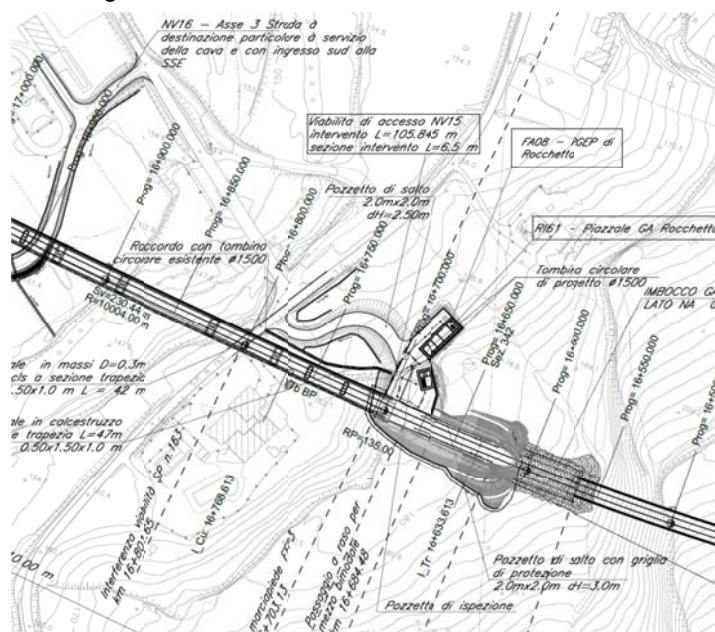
Galleria Rocchetta imbocco lato Napoli
